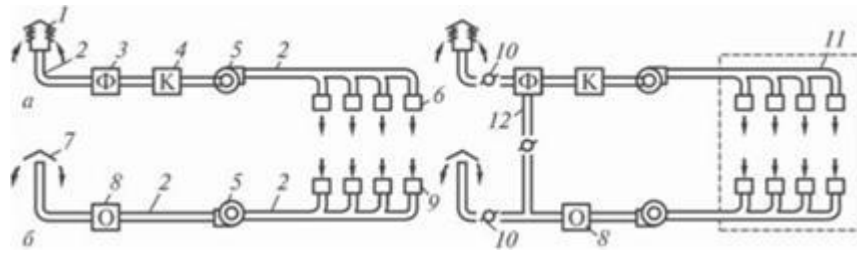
Схема припливної, витяжний і припливно-витяжної механічної вентиляції: а - припливна; б - витяжна; в - припливно-витяжна;
